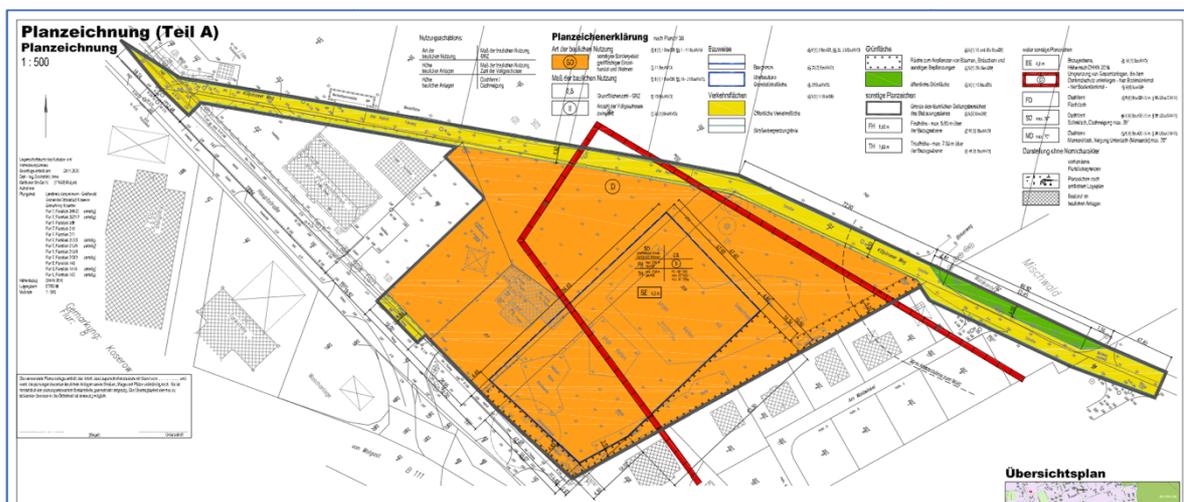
Planzeichnung zum Bebauungsplan Stand 02/2025
